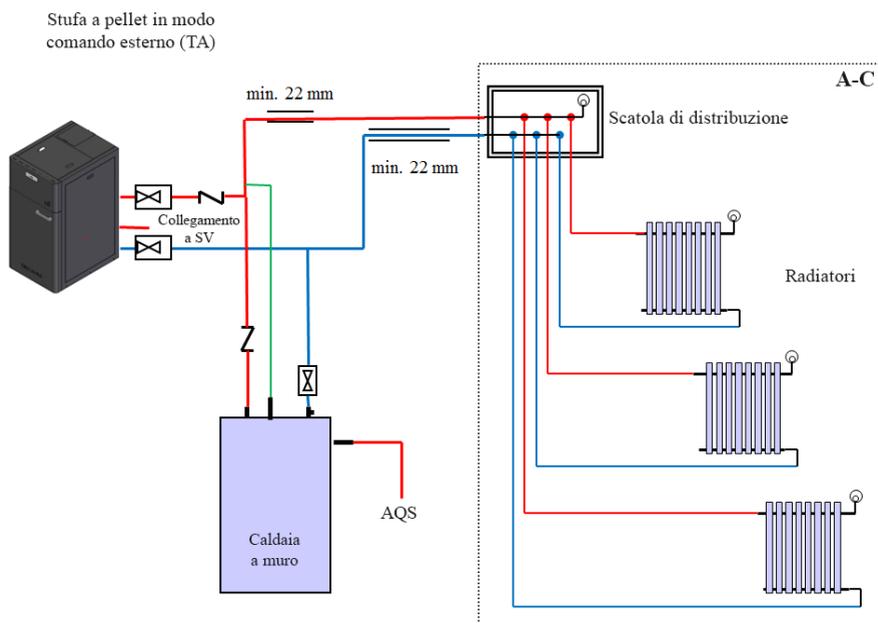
Schema d'installazione per riscaldamento centrale a pellet con l'appoggio di caldaia a muro.
